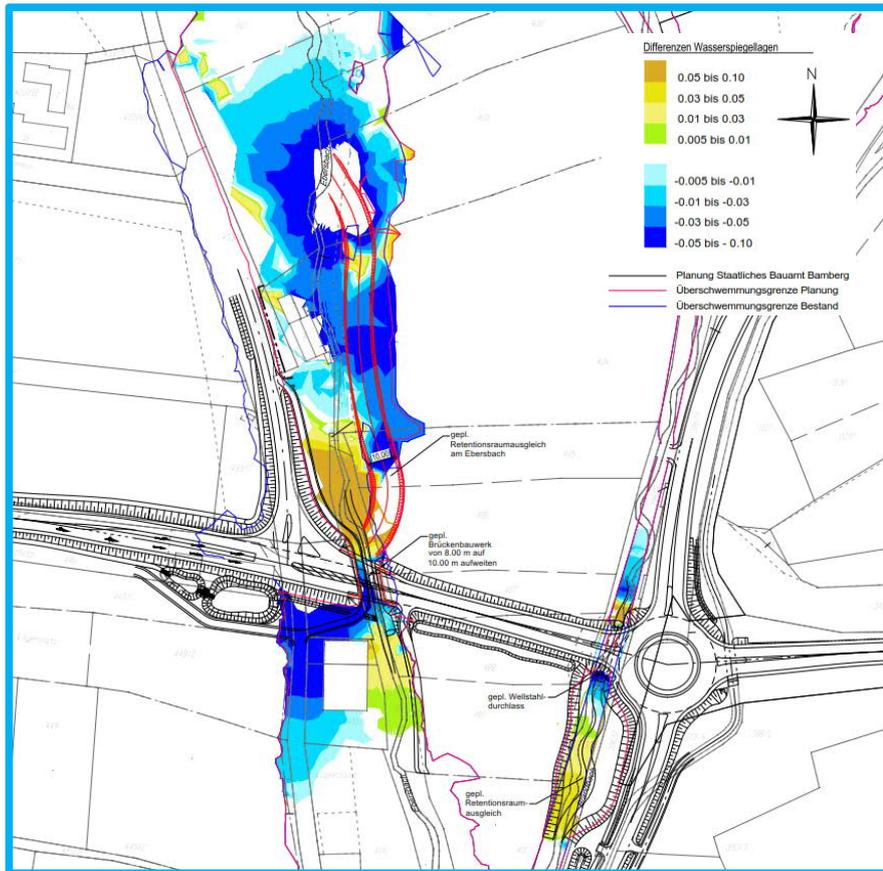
Differenzdarstellung Bestand – Planung, Bereich OU
